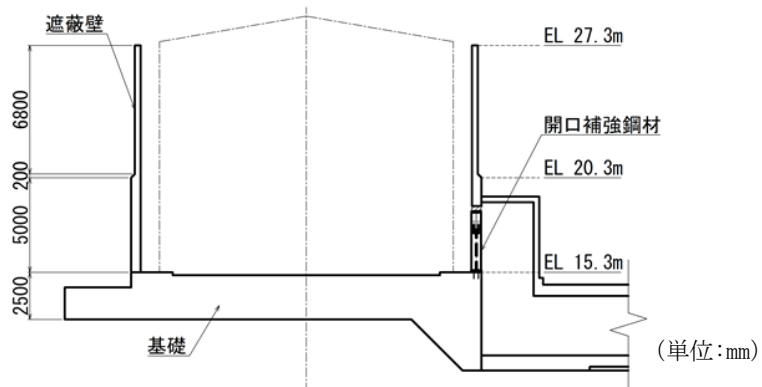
復水貯蔵タンク遮蔽壁 断面図 (A-A断面)
